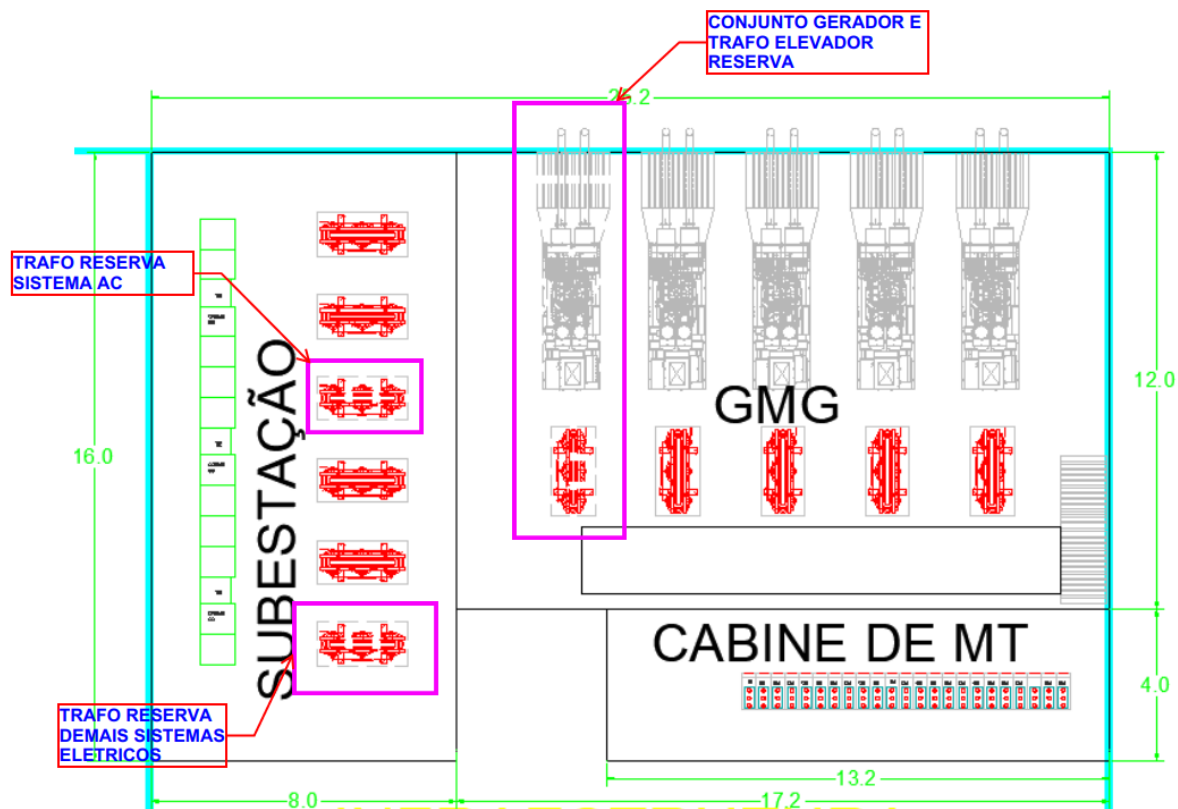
Compatibilização – Planta do 2º Subsolo e localização da Subestação, GMG e Cabine de MT
